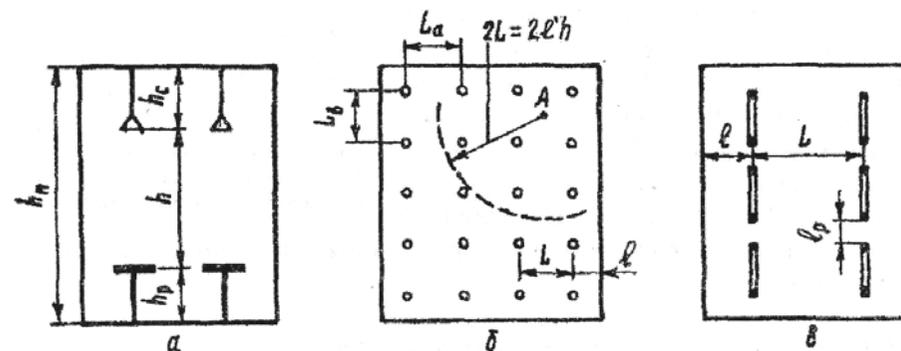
Расположение световых приборов: а – разрез помещения; б и в – план помещения соответственно с точечными и линейными излучателями.
